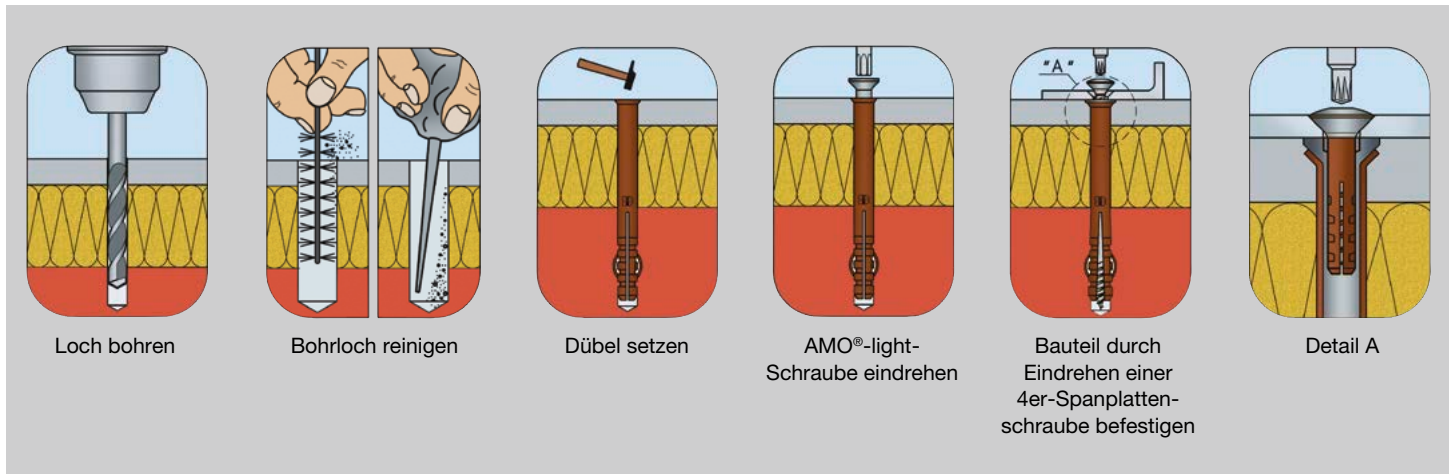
Montage einer AMO®-light-Schraube in einem Vollziegelstein
